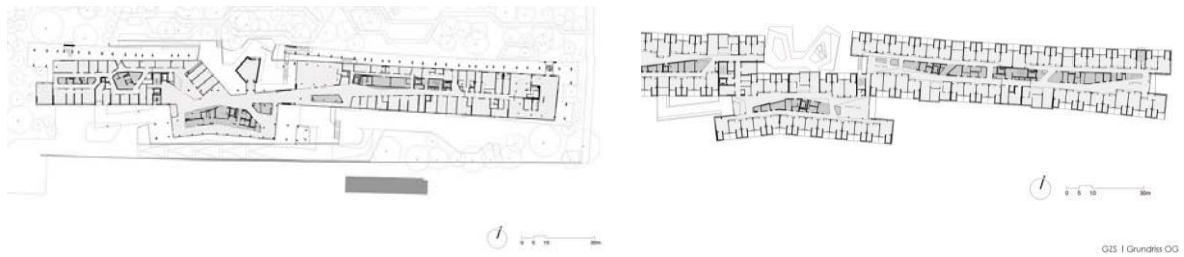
Planta 1 y 2 de Residencia. (Weichenbrger, Josef)
